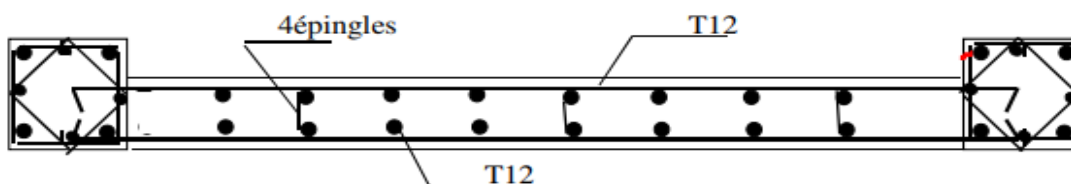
Schéma de ferrailage du Voile V=2,8m (niveau R.D.C)
